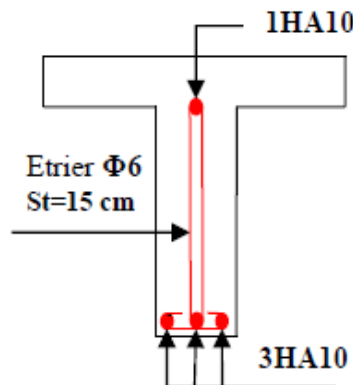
Schémas de ferrailage des poutrelles isostatique
